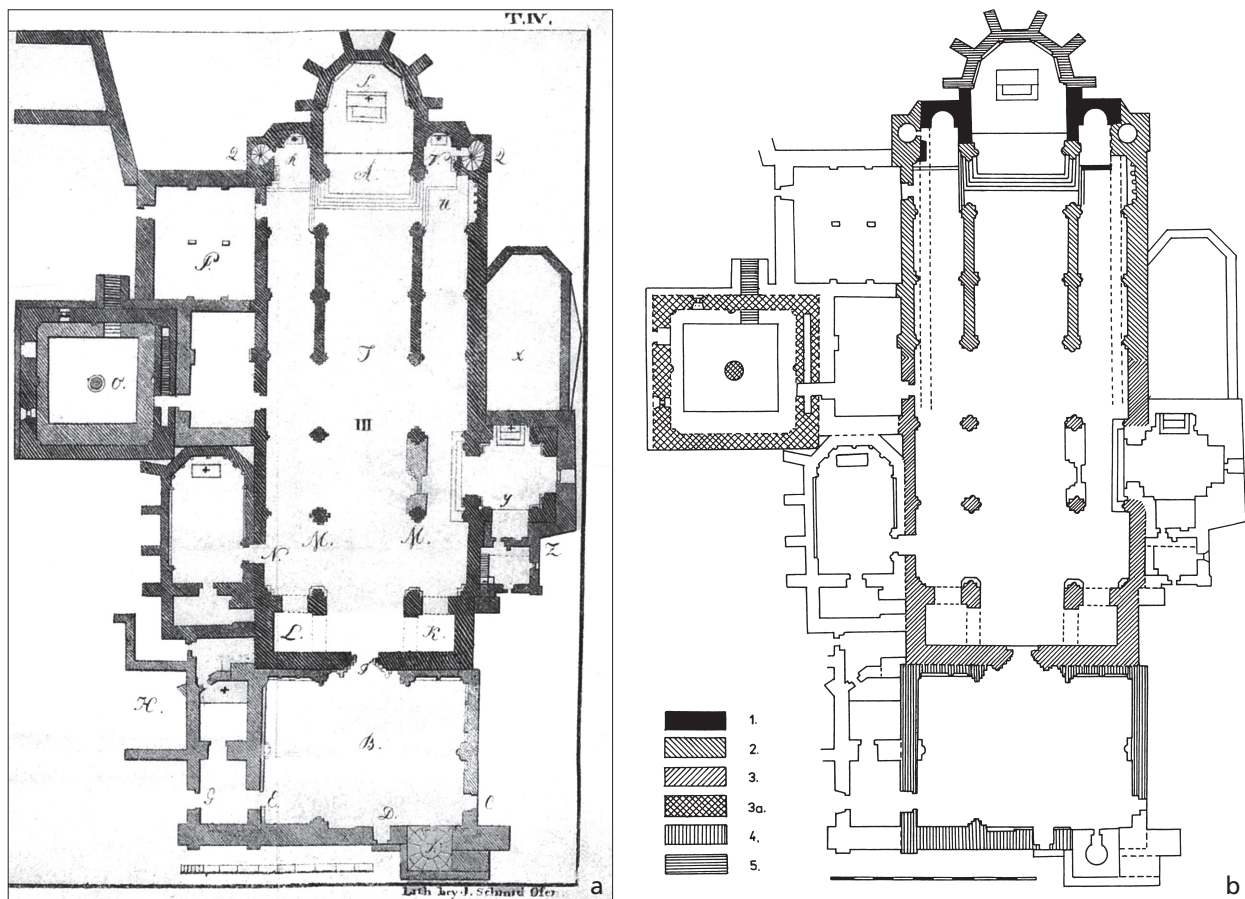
Gran – Burgberg (Esztergom – Várhegy, H): a Grundriss der mittelalterlichen St. Adalbert-Kathedrale, Bestandsaufnahme Máthés. – b Grundrissinterpretation von I. Horváth. – (a nach Marosi 1984, 280 Abb. 7; b nach MRT 5, 103 Abb. 16).
